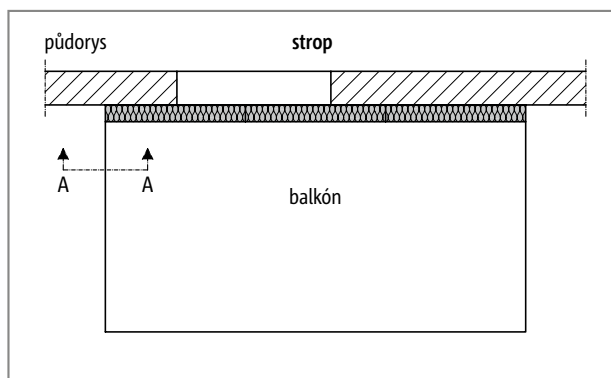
Schöck Isokorb® XT typ KL: Napojovací stavební výztuž u nepřímého uložení
